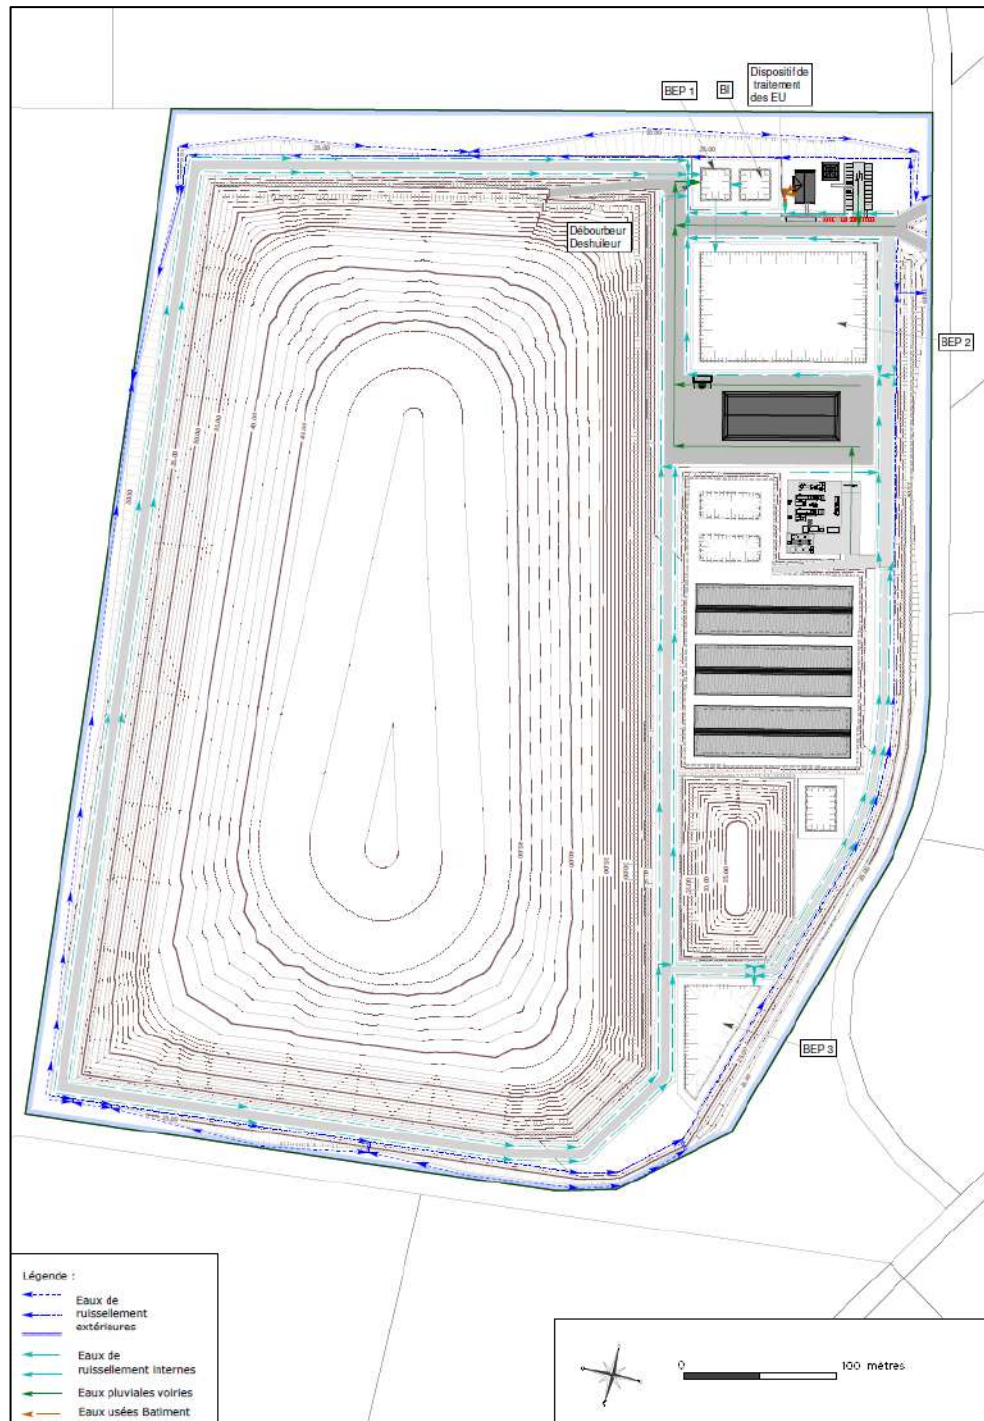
Plan du réseau de gestion des eaux pluviales (Source : BETA – Dossier technique)
